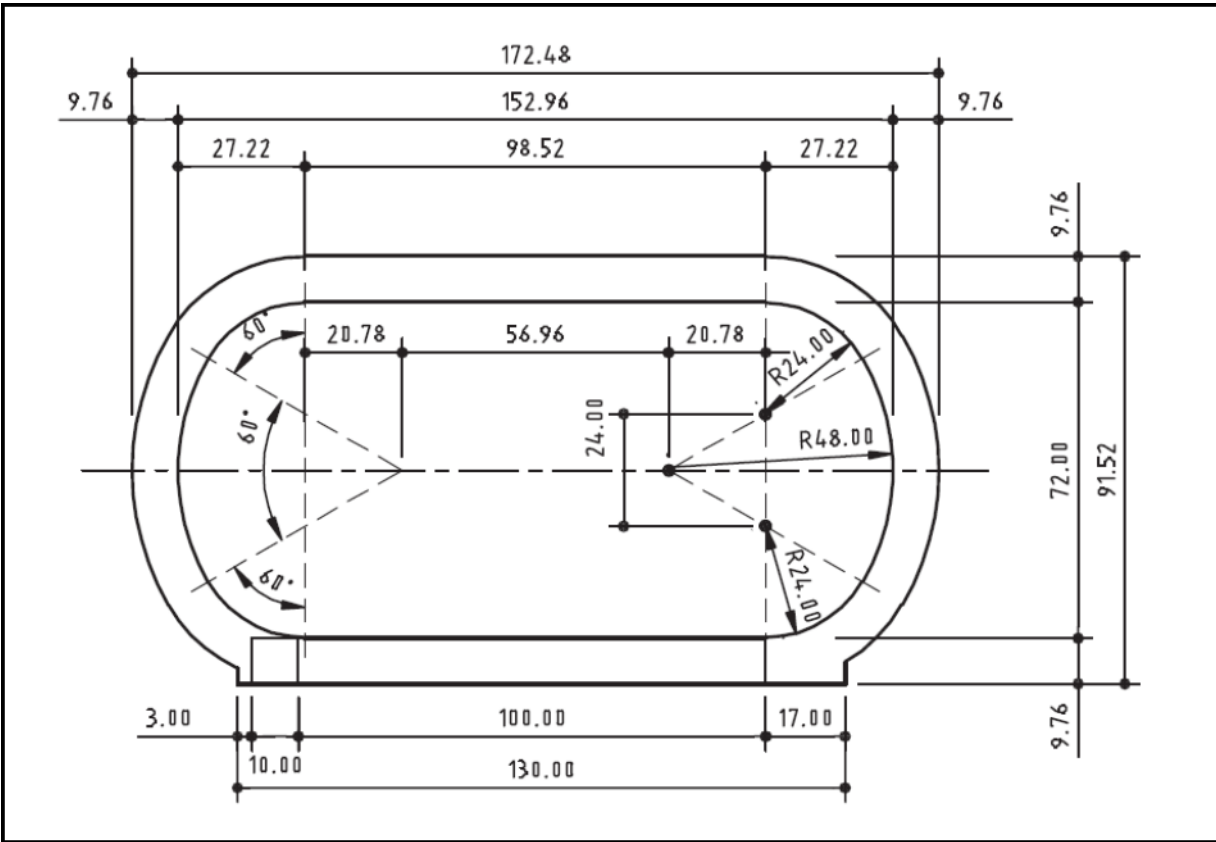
forme et dimensions de la piste de 400m à deux rayons en virage, R 48,00 et 24,00 (dimensions en m)
